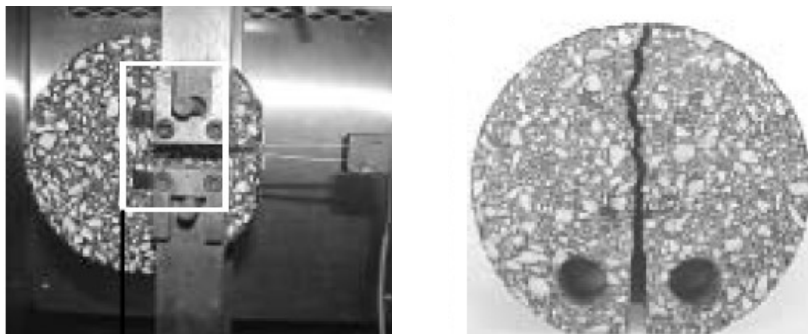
Ensayo DC(T) y propagación de la fisura con la geometría de la probeta propuesta
